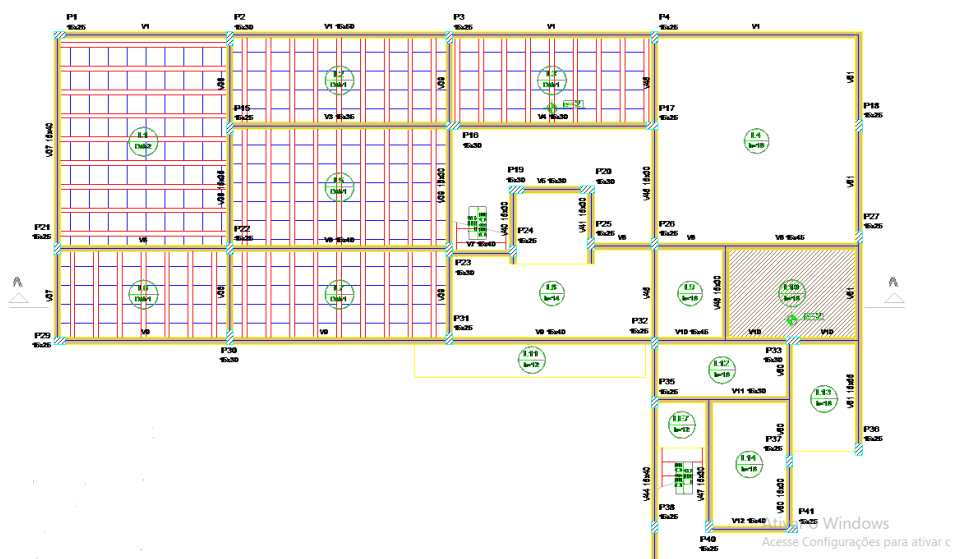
Planta de forma das fundações e vigas baldrame do bloco administrativo.
